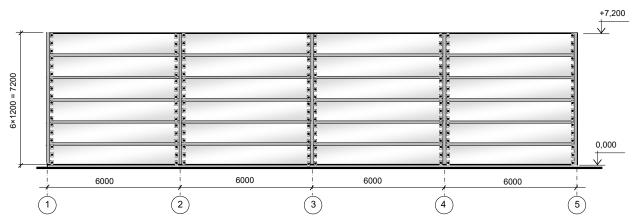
Схематичный фасад производственного здания (к примеру расчета И.2)
